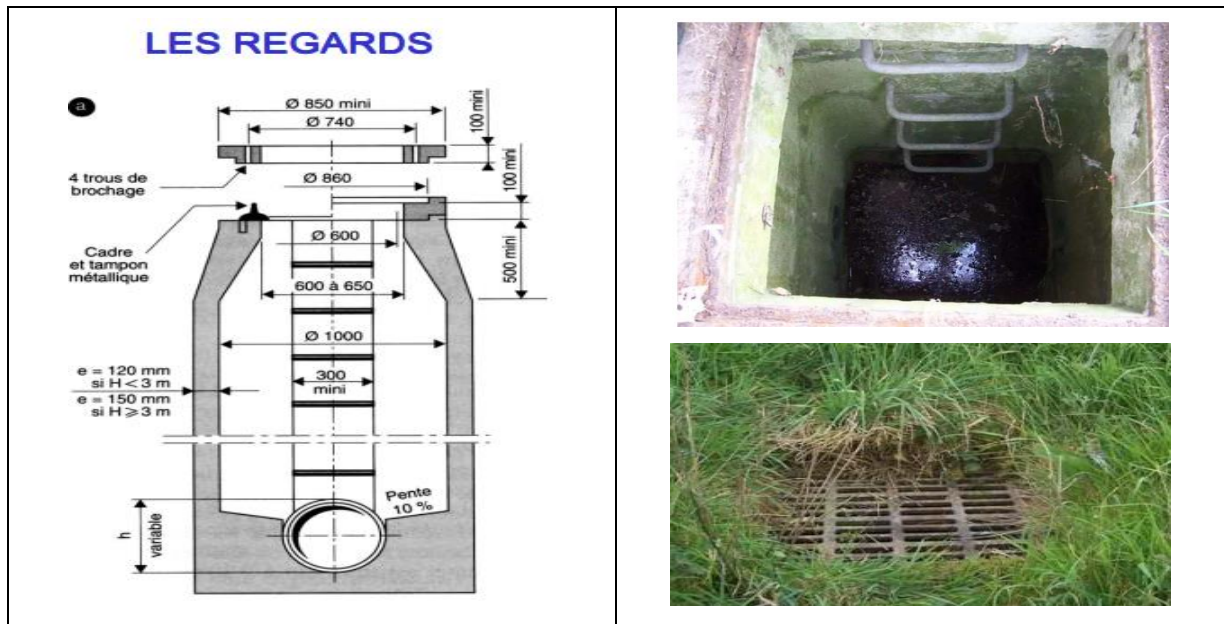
et Photo 2.9 : Schéma d'un regard de visite
